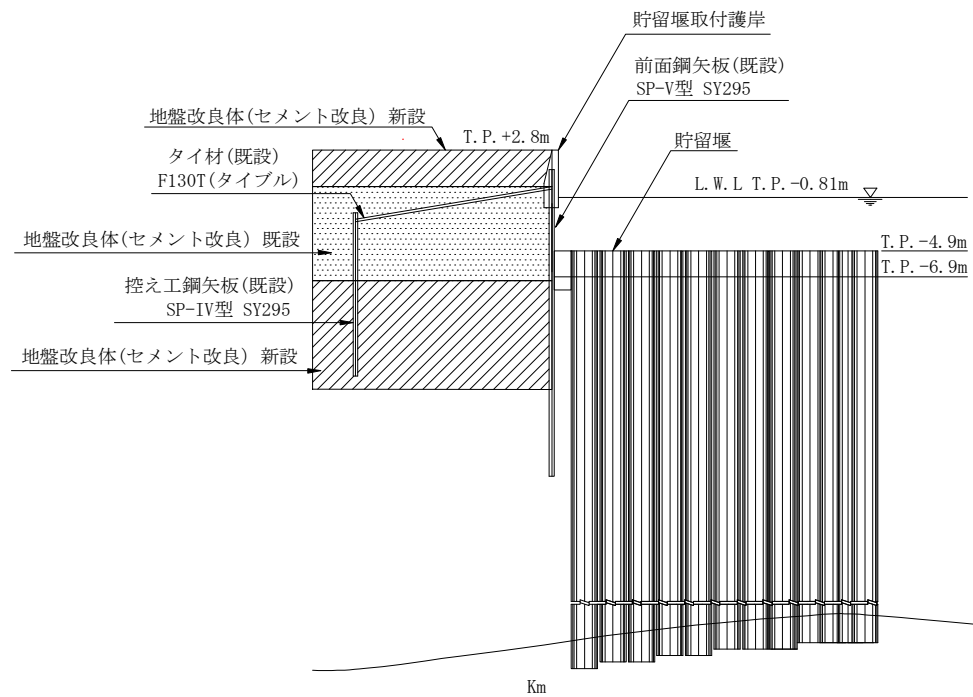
貯留堰取付護岸の標準断面図 (A-A 断面)
